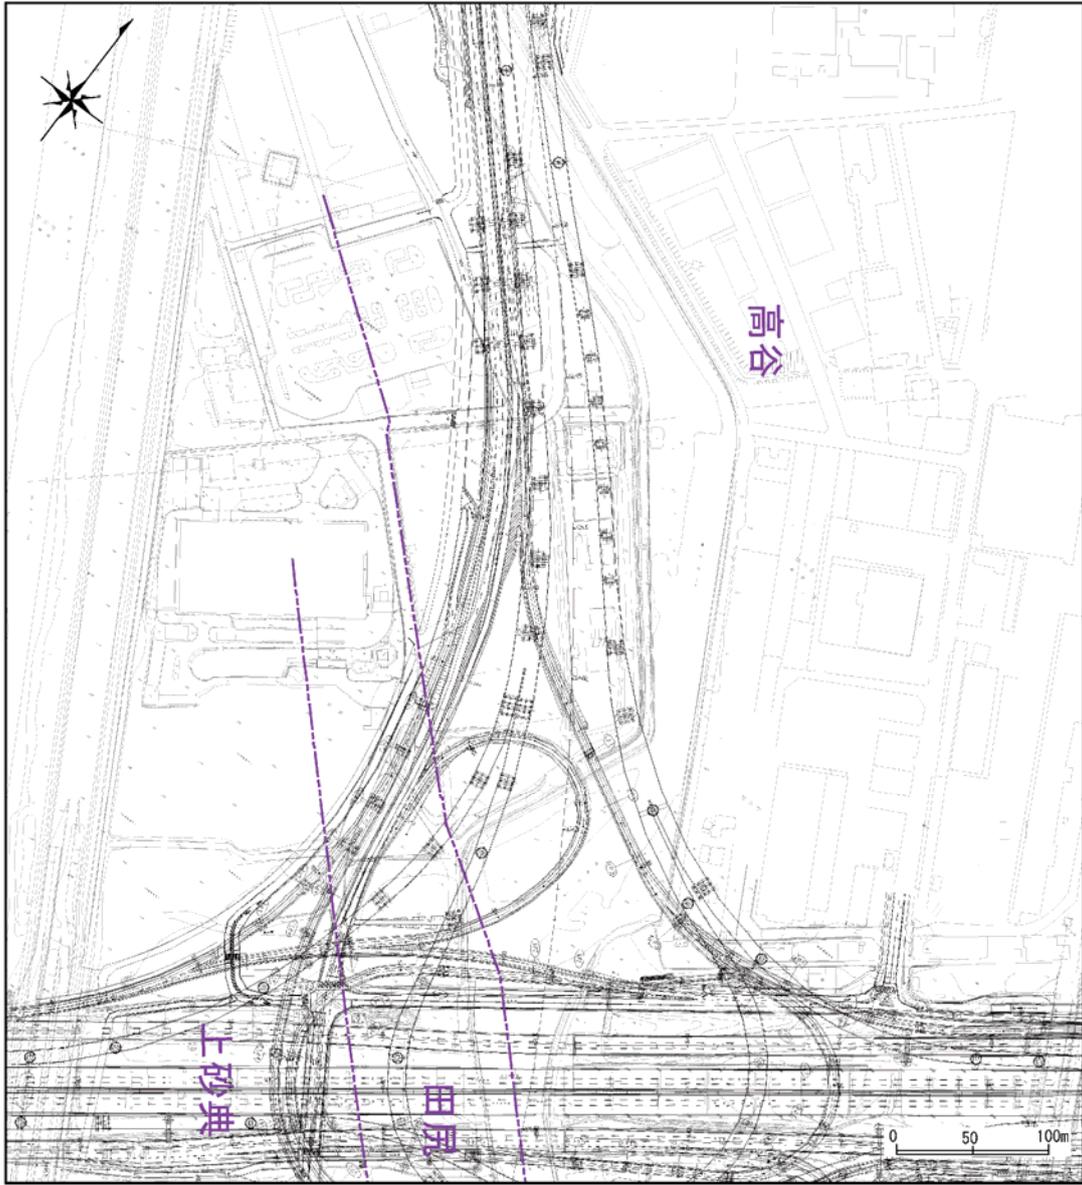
(15) 特殊部予測平面图 (高谷 JCT)
